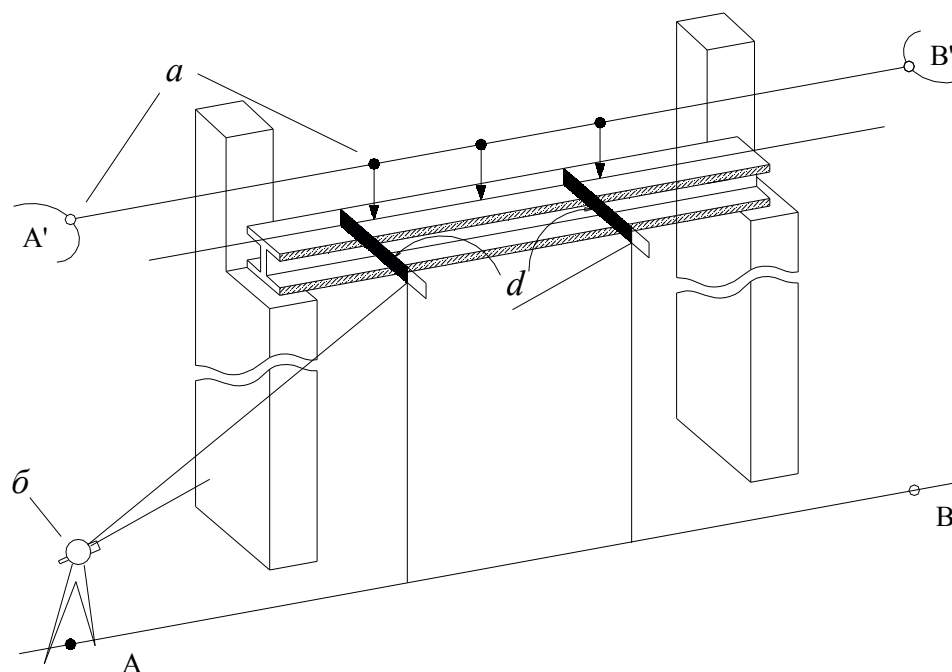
Разбивка для монтажа подкрановых путей
